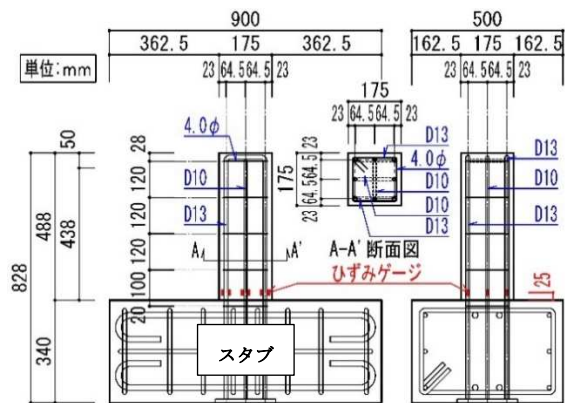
基準試験体の形状、寸法及び配筋詳細⁵⁾
